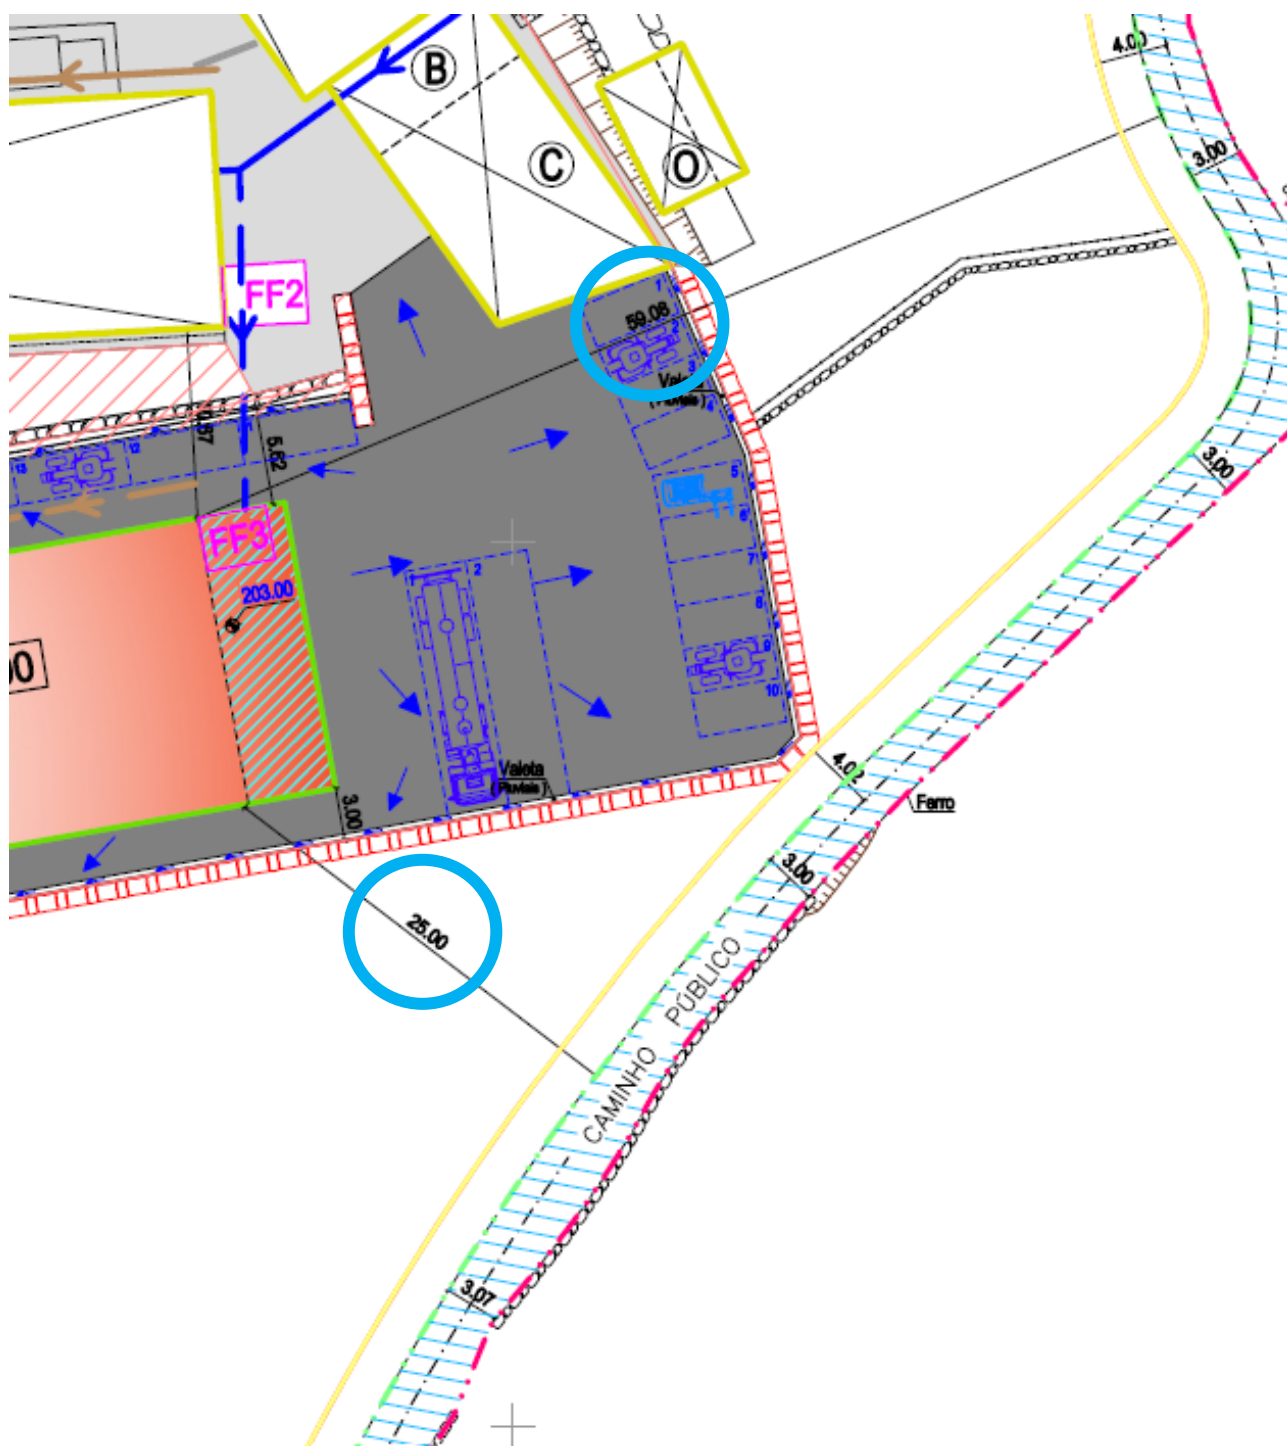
Distância do Pavilhão 3 (a construir) às extremas N-E-S
